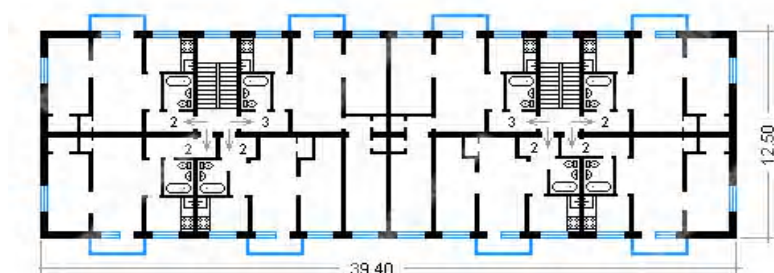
План типового этажа (типовой проект серия 1–438).
